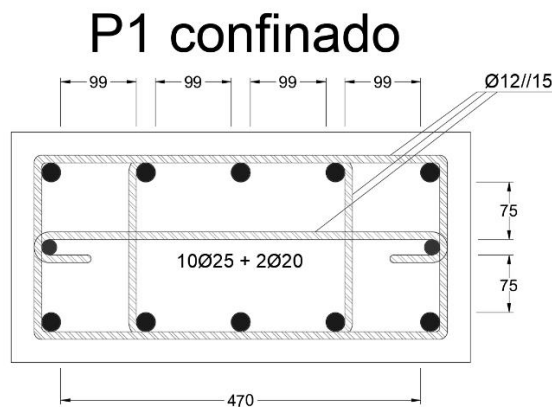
Armadura longitudinal e transversal do P1 confinado.
